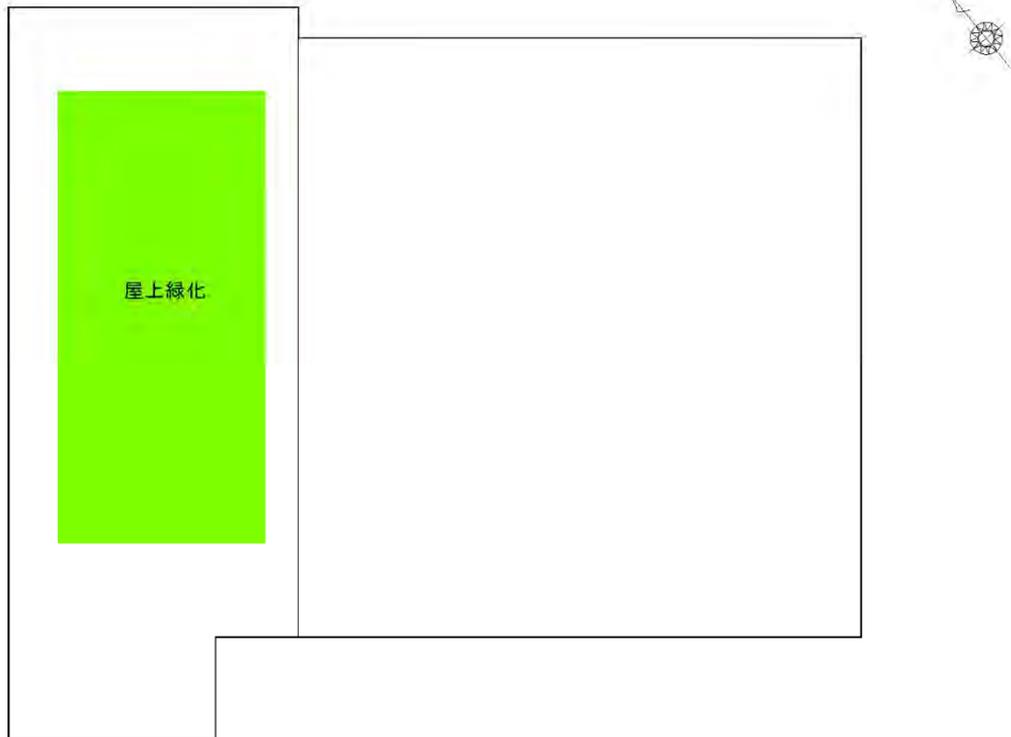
(9) 廃棄物受入棟平面図 (R 階)
